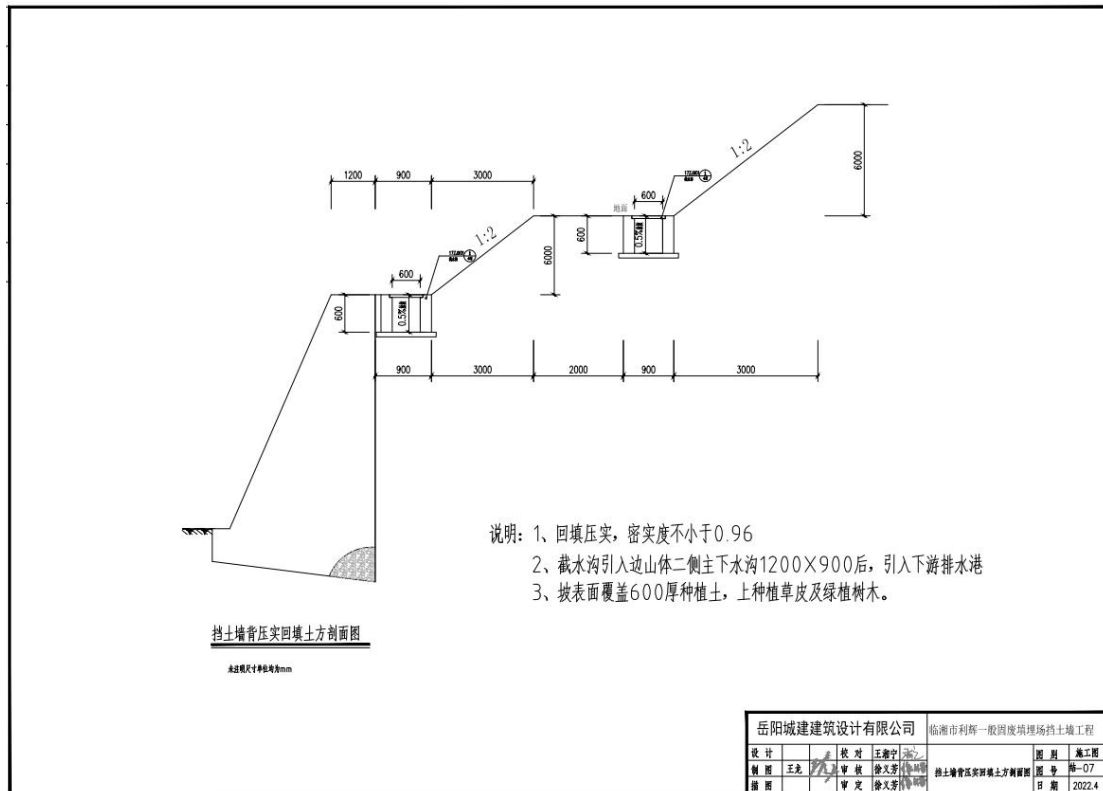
挡土坝背压实回填土方剖面图（局部）
